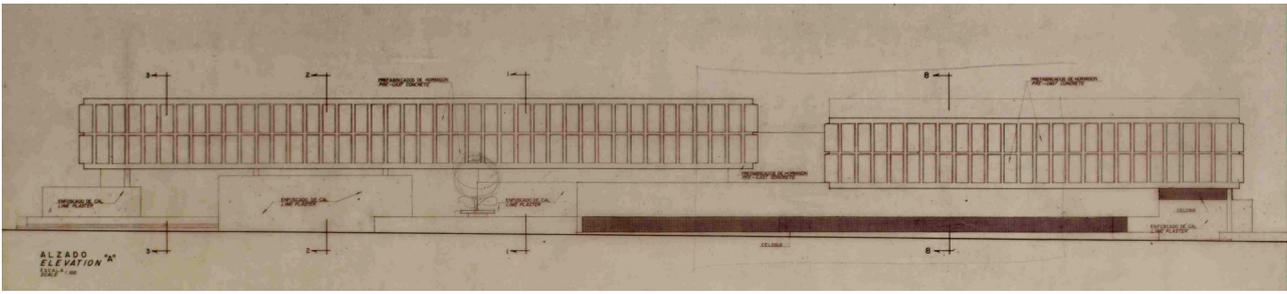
Separación entre volúmenes principales y entre planta baja y suelo. Fuente: Fondo Carvajal, Archivo General Universidad de Navarra
